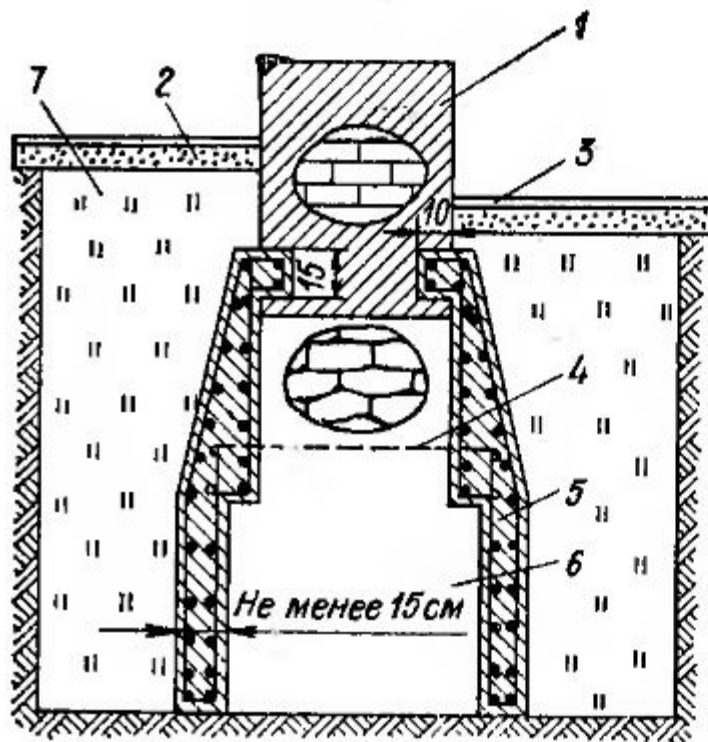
Усиление наружных фундаментов железобетонными обоймами
